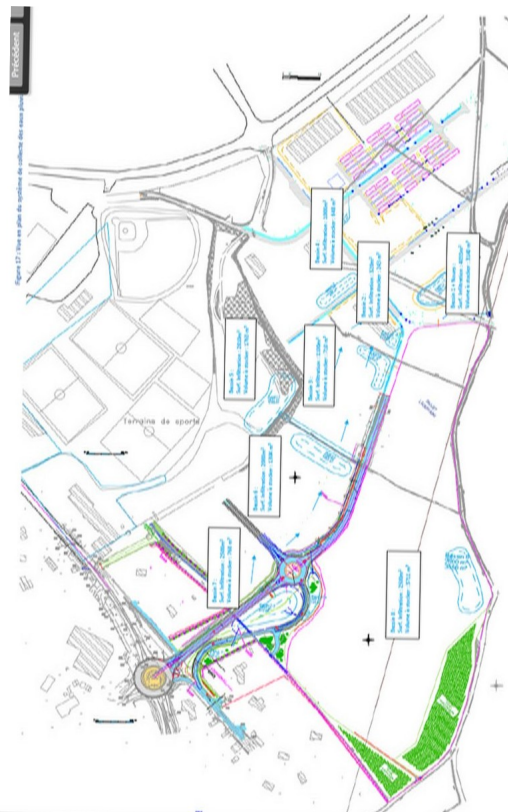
Vue en plan du système de collecte des eaux pluviales
